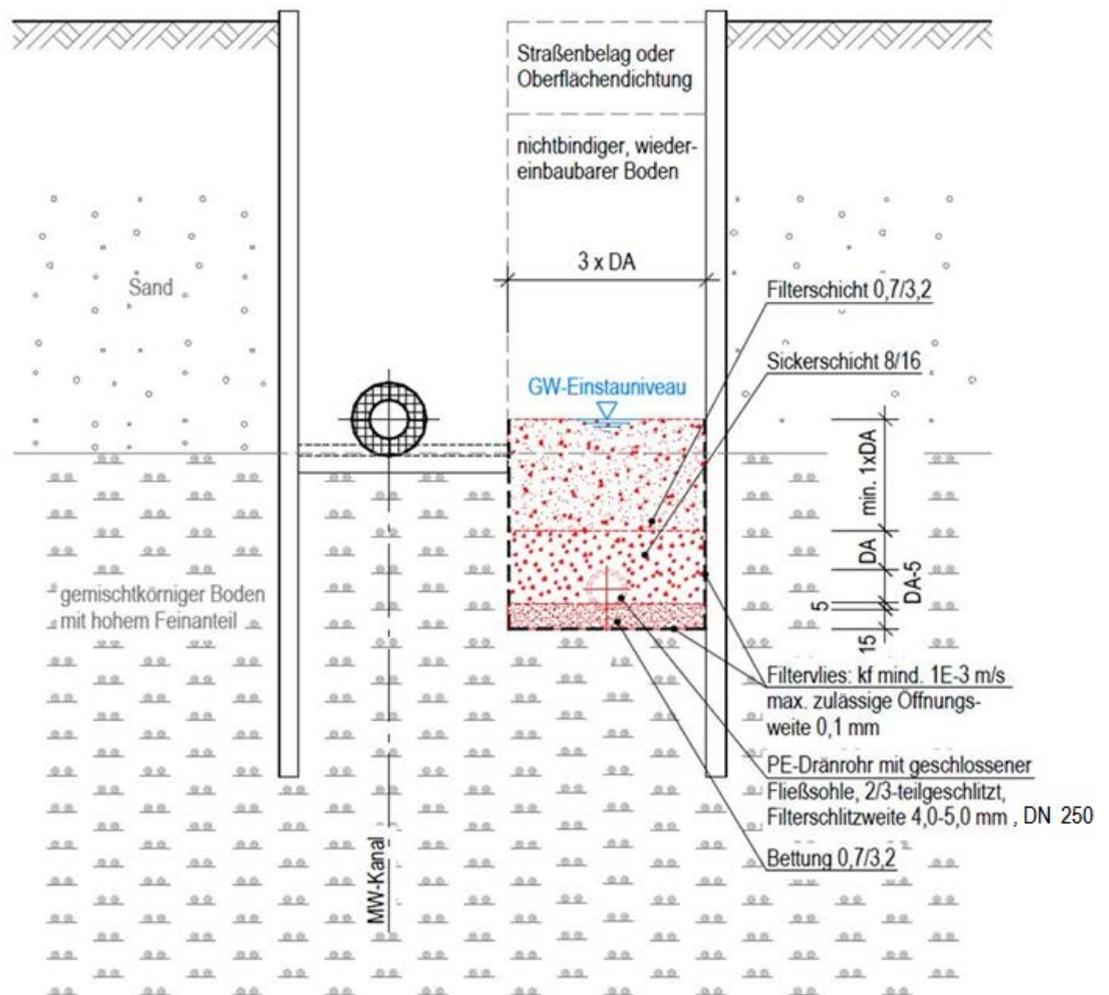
Beispielhafter Aufbau der horizontalen Grundwasserfassungsanlage mit Geotextil in einem gemischtkörnigen Boden mit hohem Feinkornanteil
